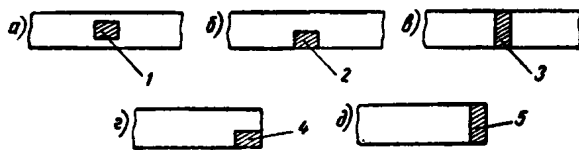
Схемы приложения нагрузок при расчете на местное сжатие
